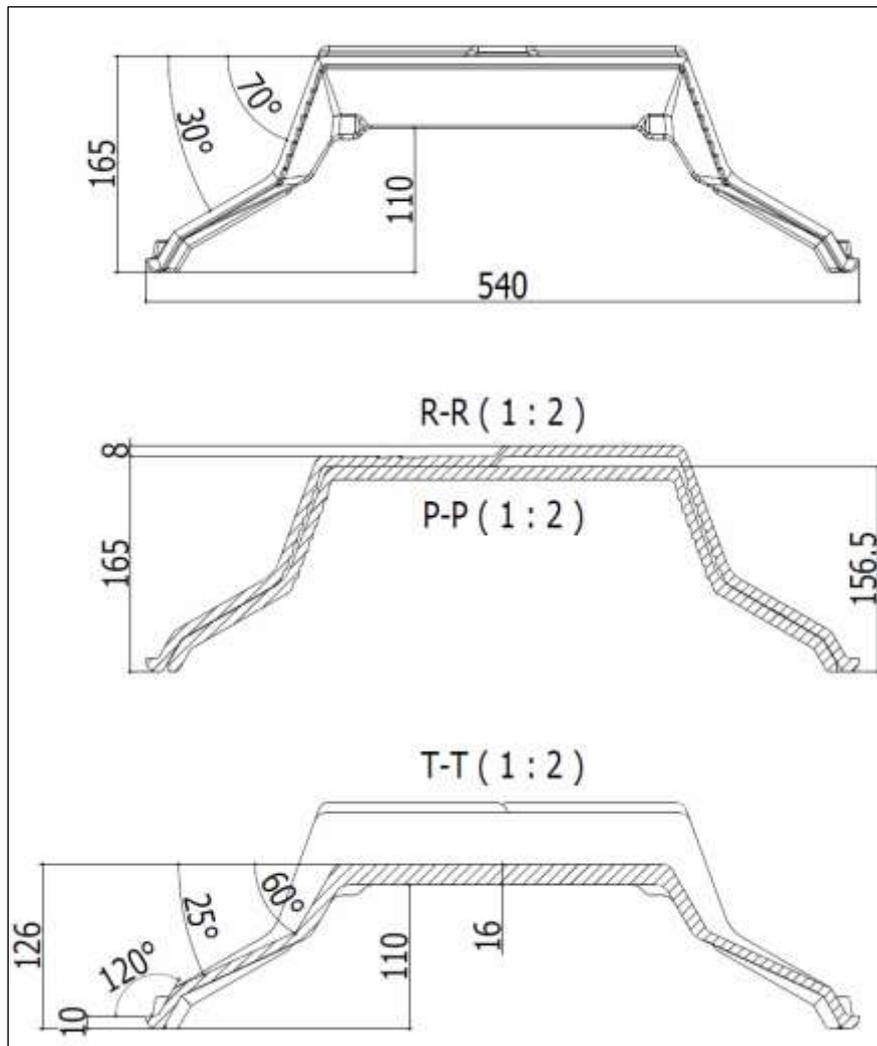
Entrevous Fabribois ou Duranlight (longueur 1200 mm) Hauteur coffrante 200 mm
